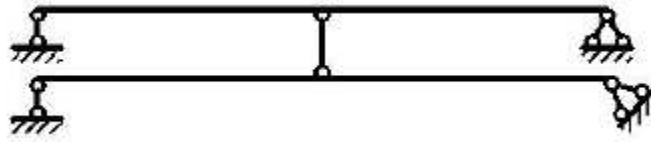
Схема к расчету усиления балки устройством дополнительных упругих опор
